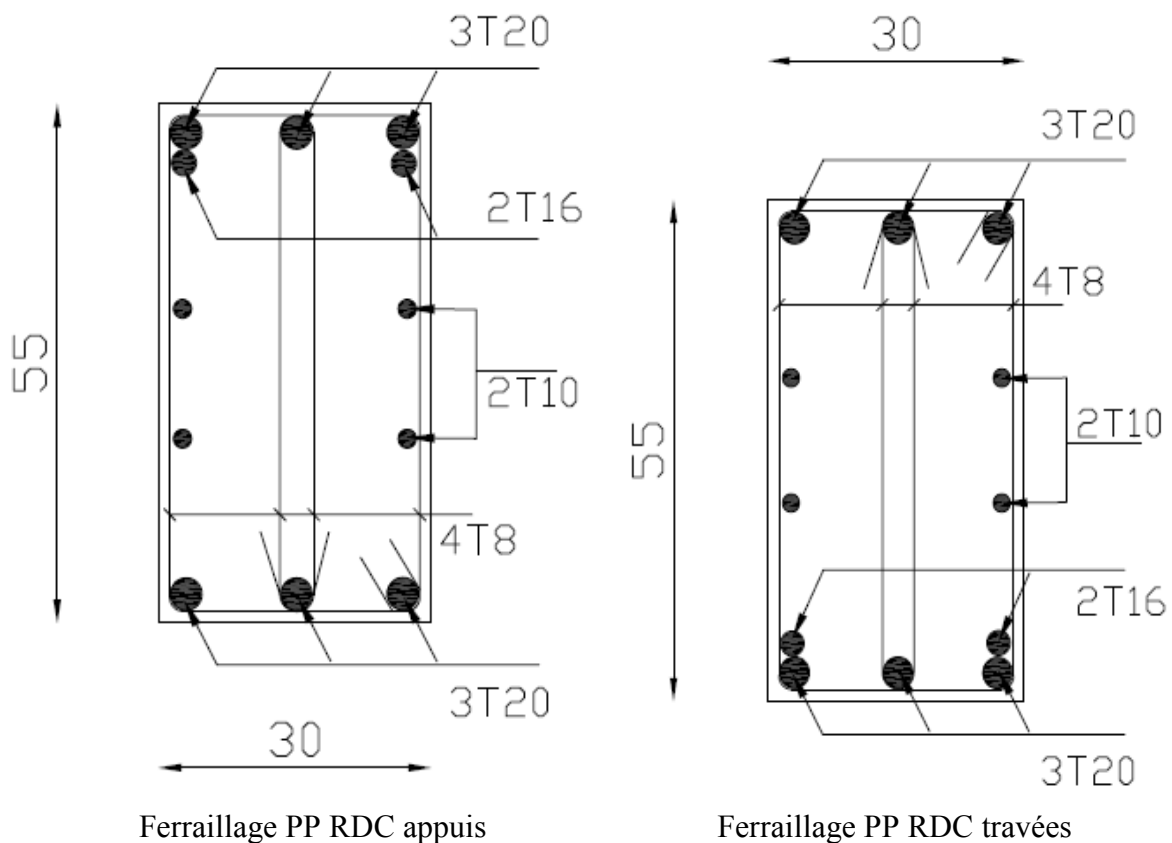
Exemples Schéma de Ferrailage des Poutres.
